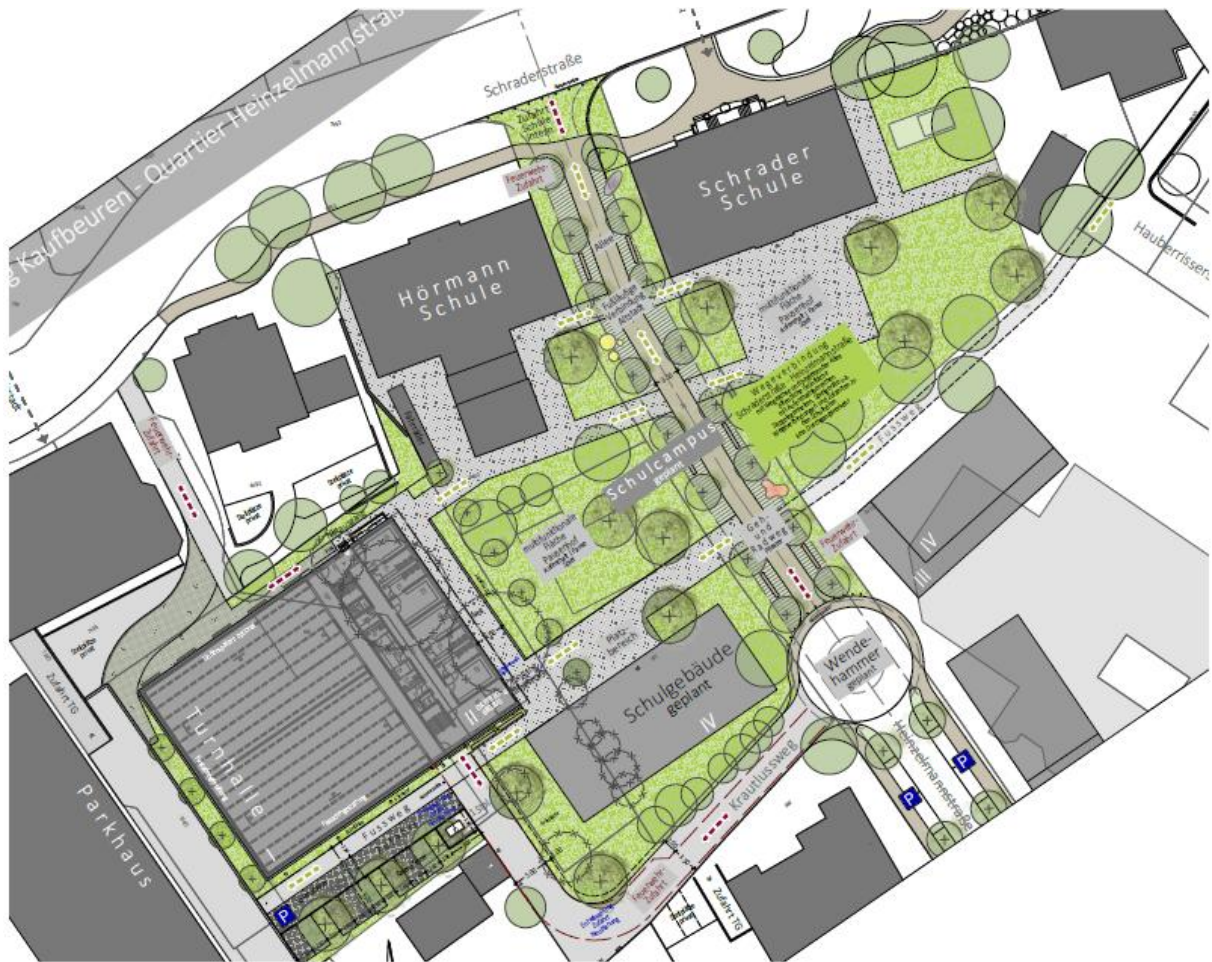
Lageplan: Neubau Doppelsporthalle am Krautlussweg mit Außenanlagengestaltung
